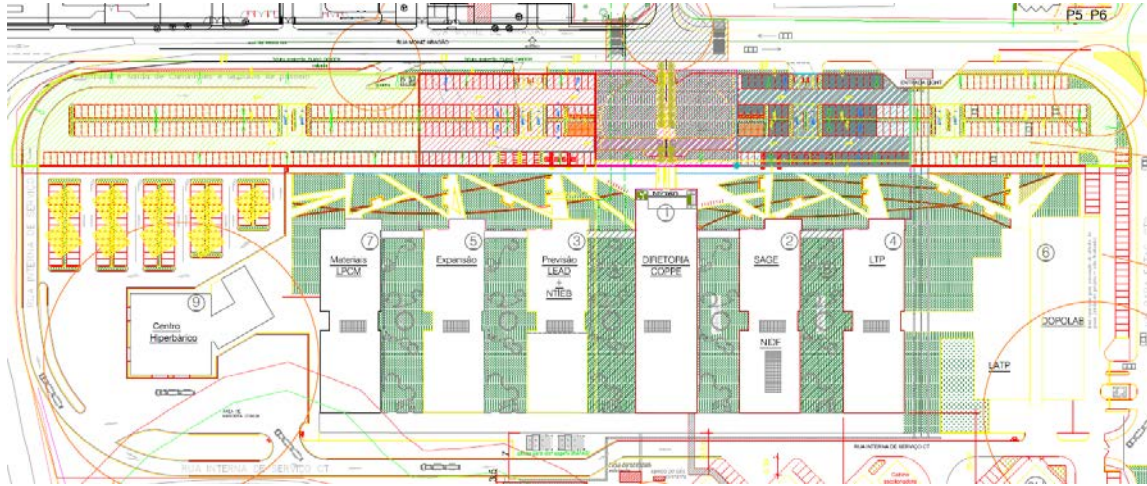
Planta de situação e localização do estacionamento do Complexo CT-2.
